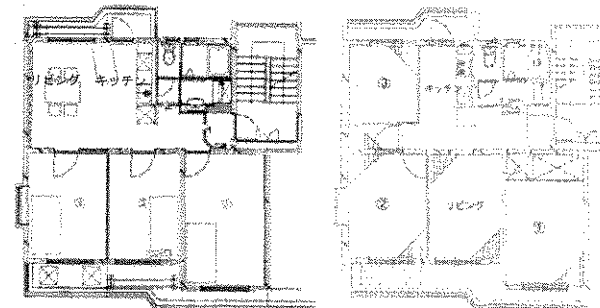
改修後平面図(左図N,C2タイプ/右図C1タイプ)
